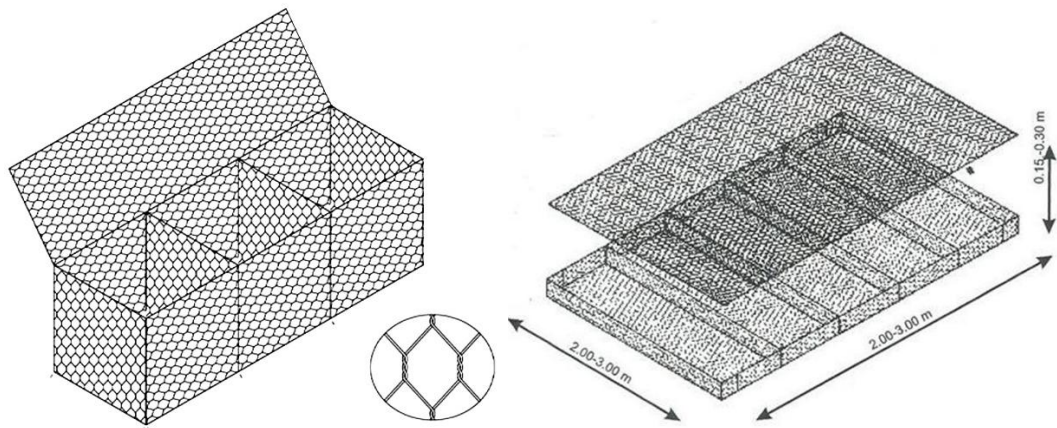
Gavión Tipo Caja y Tipo Colchón Antisocavante
